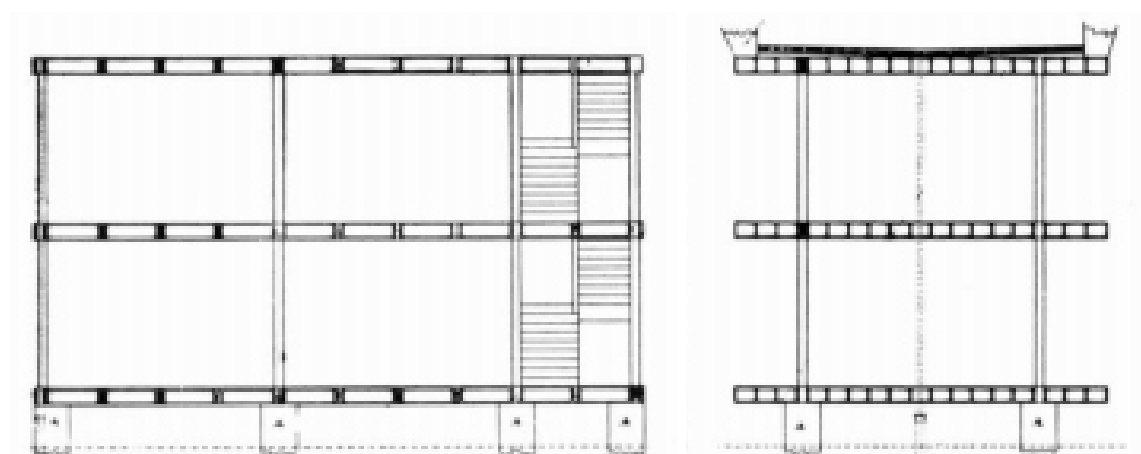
Secção transversal e longitudinal de uma casa tipo Dom-Ino.
